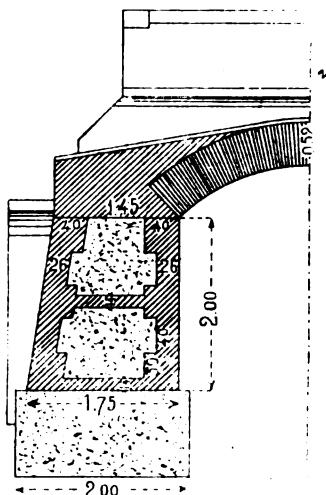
Sezione di manufatto con spalla a struttura mista.
